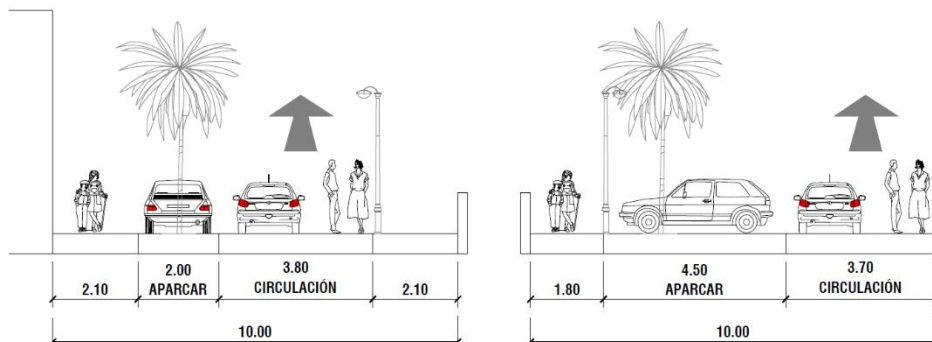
Sección Calle de Convivencia de 10 metros con aparcamientos en línea o batería.
